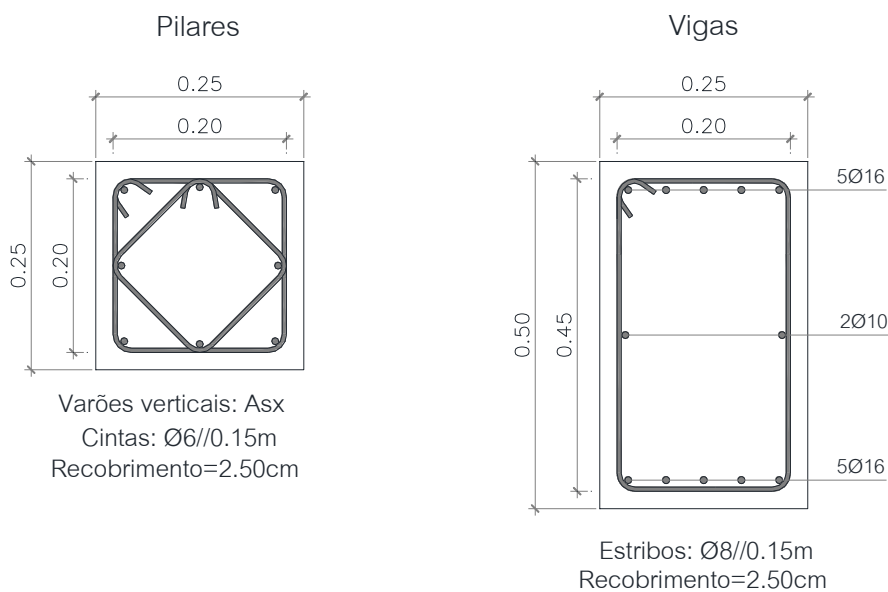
Pormenorização de pilares e vigas para os exemplos 1 e 2
